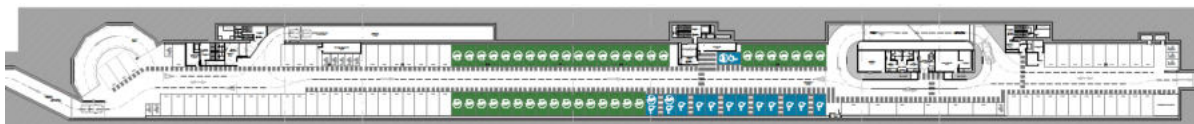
Resumen de la propuesta de distribución de la planta sótano 1
